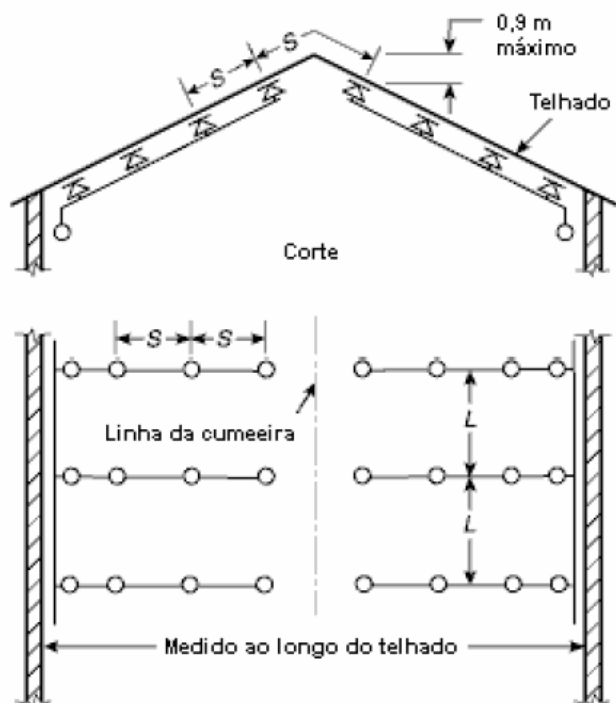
Sprinklers sob telhados inclinados; Sub-ramais acompanham a inclinação do telhado [9].
